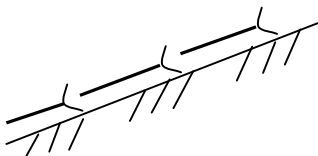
Схема укладки розтрубних труб в траншеях з великим ухилом
